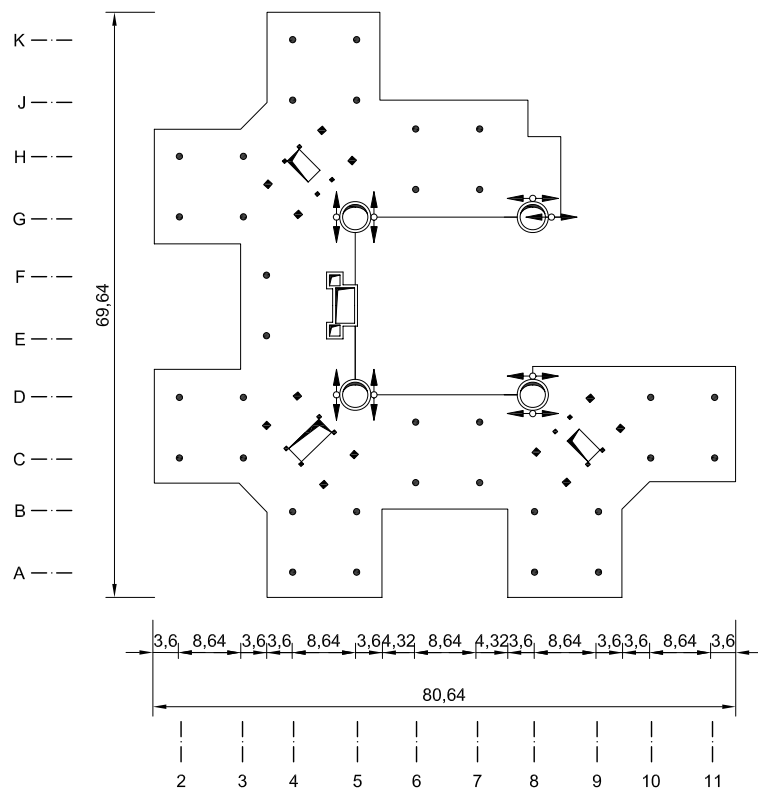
Grundriss mit aussteifenden runden Treppentürmen – die Pfeile geben die konstruktiv geschaffenen Verschiebungsfreiheitsgrade der Decken an [5]
